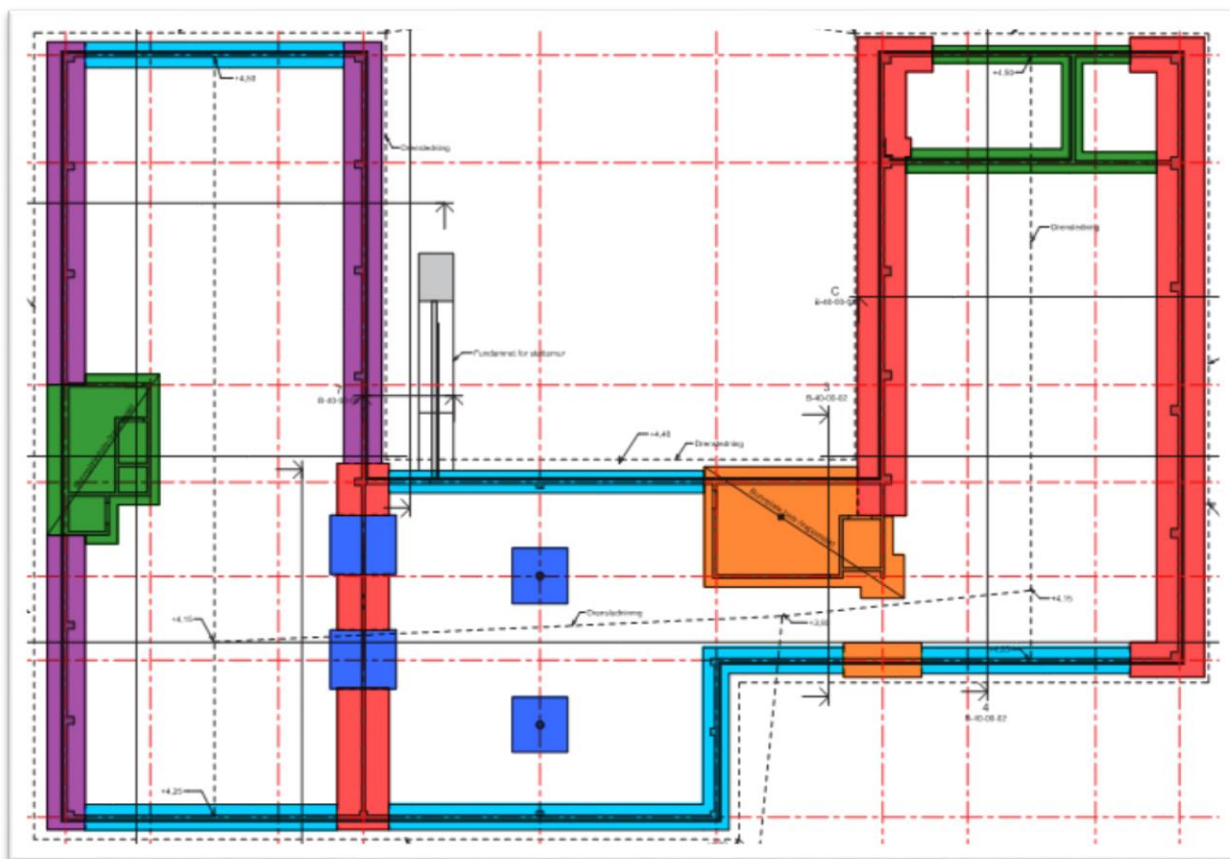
Modell av byggegroppen. Skjerm bilde fra Autocad.
